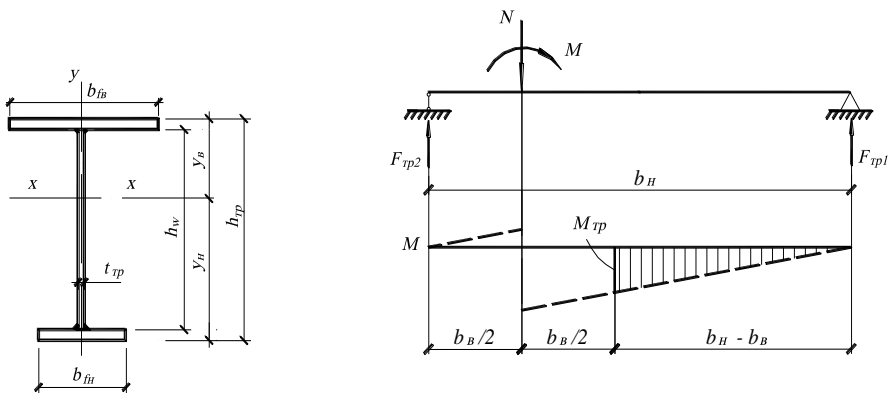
Поперечное сечение и расчетная схема траверсы уступа колонны
